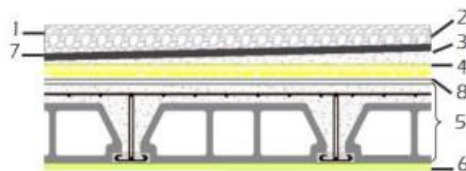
Coupe transversale du plancher terrasse inaccessible
